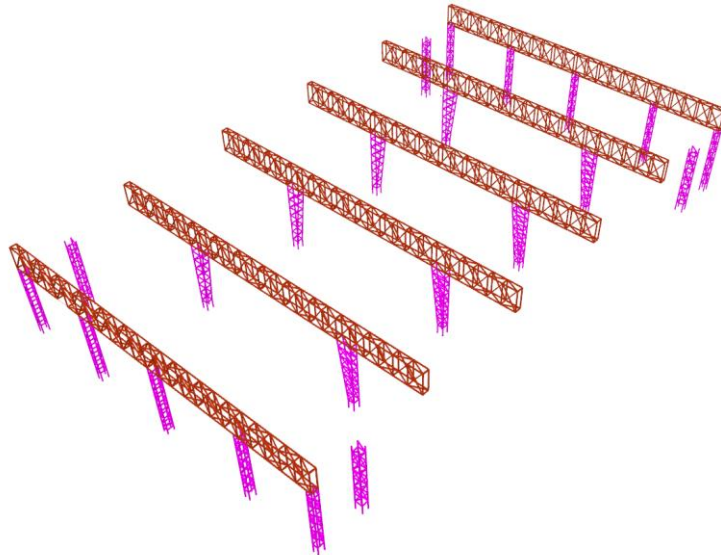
| Colocación de vigas principales sobre columnas
